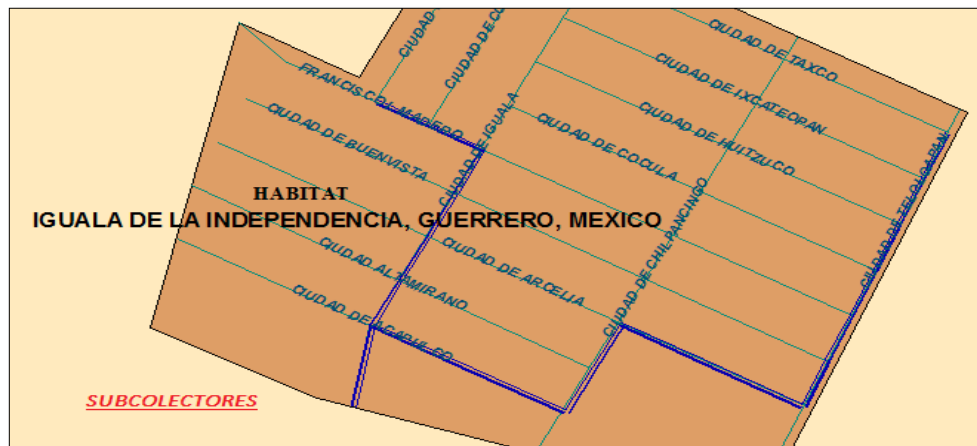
Ubicación de subcolectores de la red de alcantarillado
